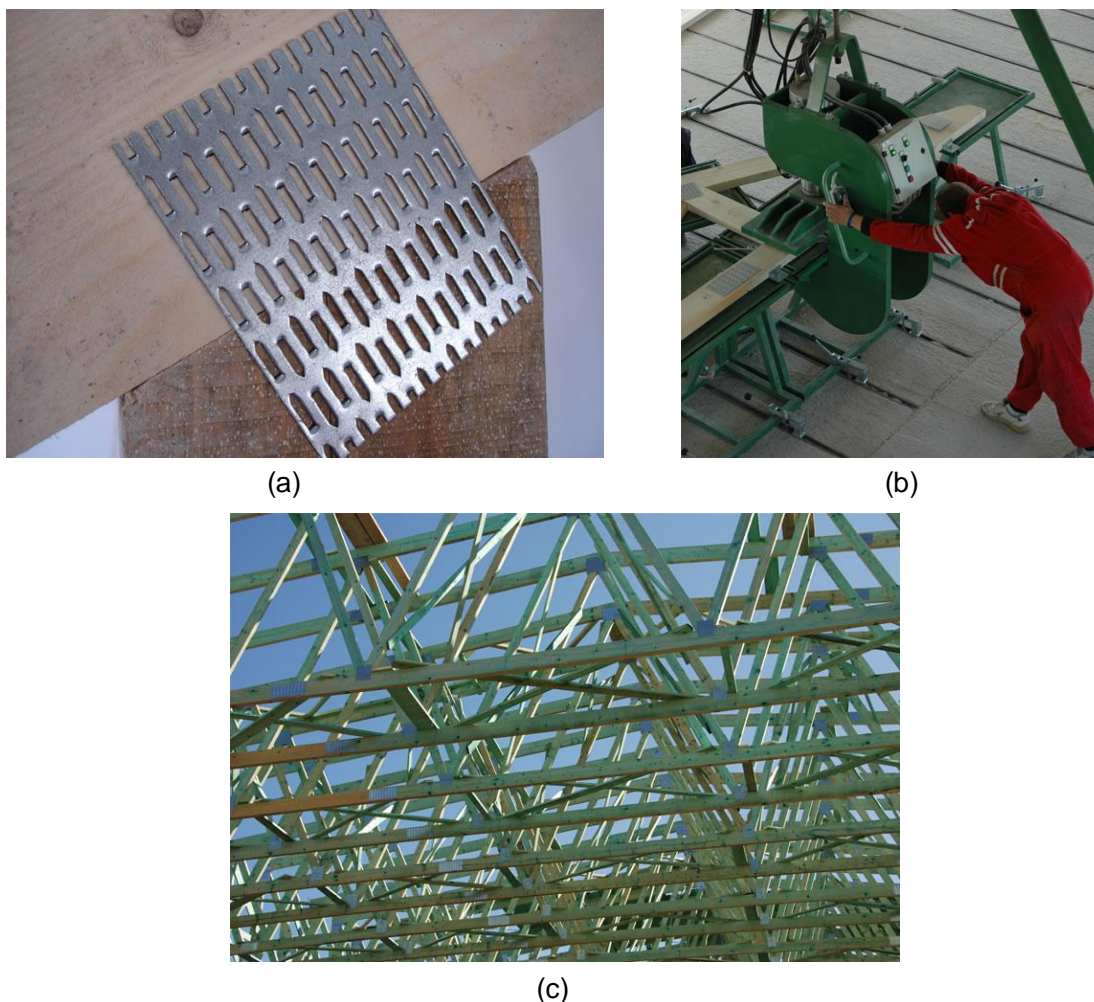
Chapas metálicas denteadas: a) pormenor da ligação entre dois elementos de madeira; b) colocação da chapa metálica através de prensa hidráulica; c) asnas de uma cobertura ligadas por chapas metálicas denteadas. Bovanail (2006).
